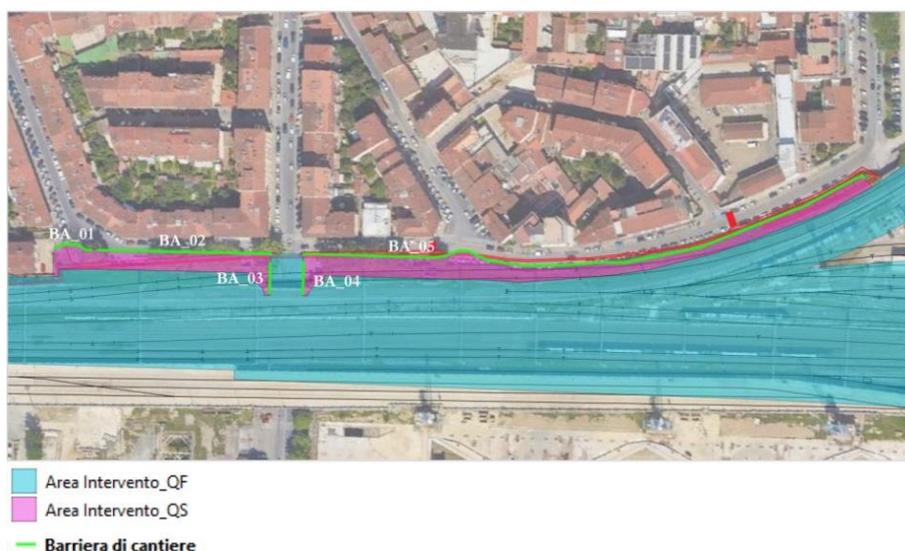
posizione della barriera antirumore a protezione del cantiere a piano strada.
